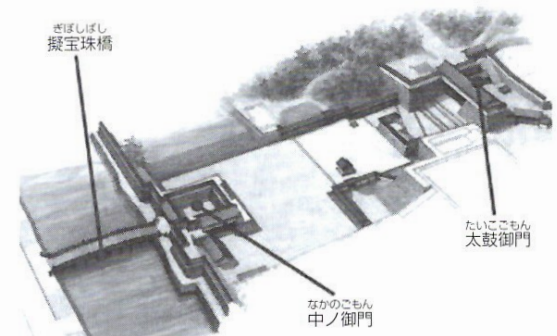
大手登城路復元整備予想図（鳥取市教育委員会提供）
